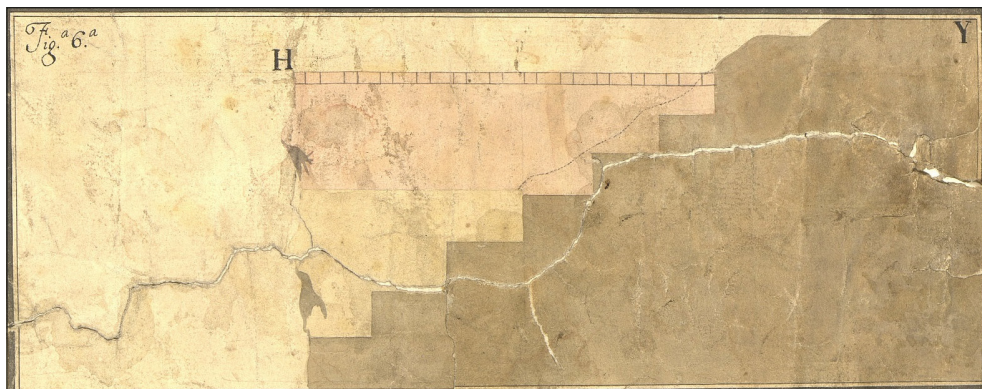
Sección del estribo occidental de la nueva pared (sección 6 del plano).
